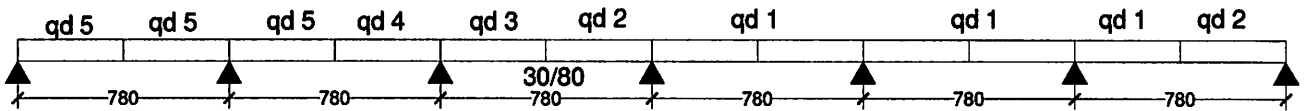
Denah Balok yang terbebani pelat Lantai Atap
